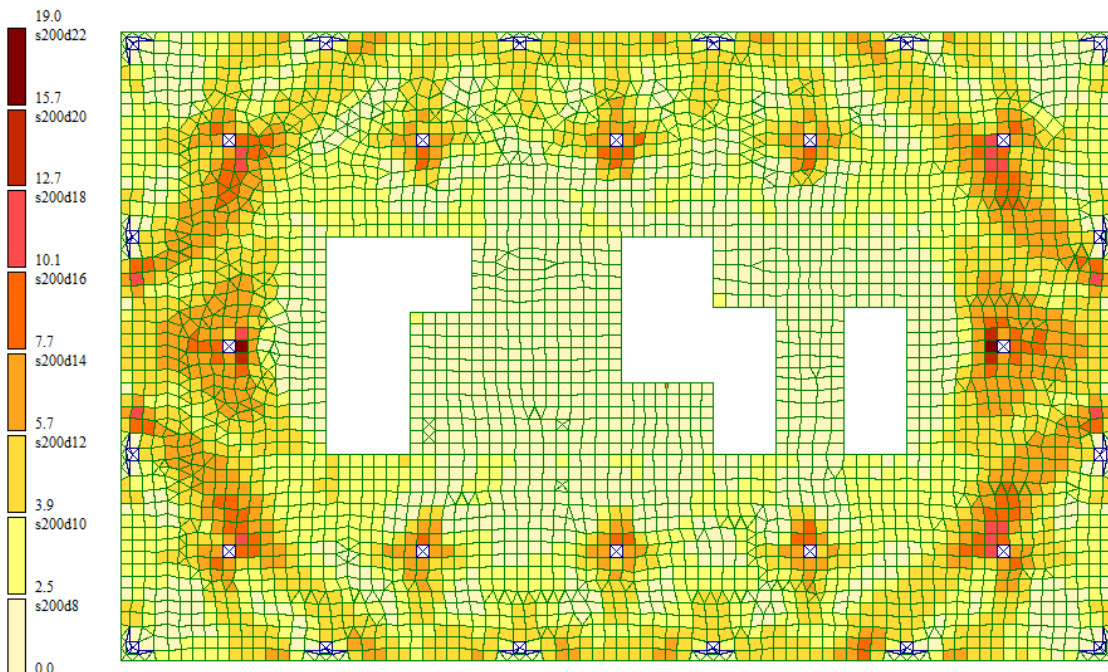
Схема армирования низа плит перекрытий по оси OX
